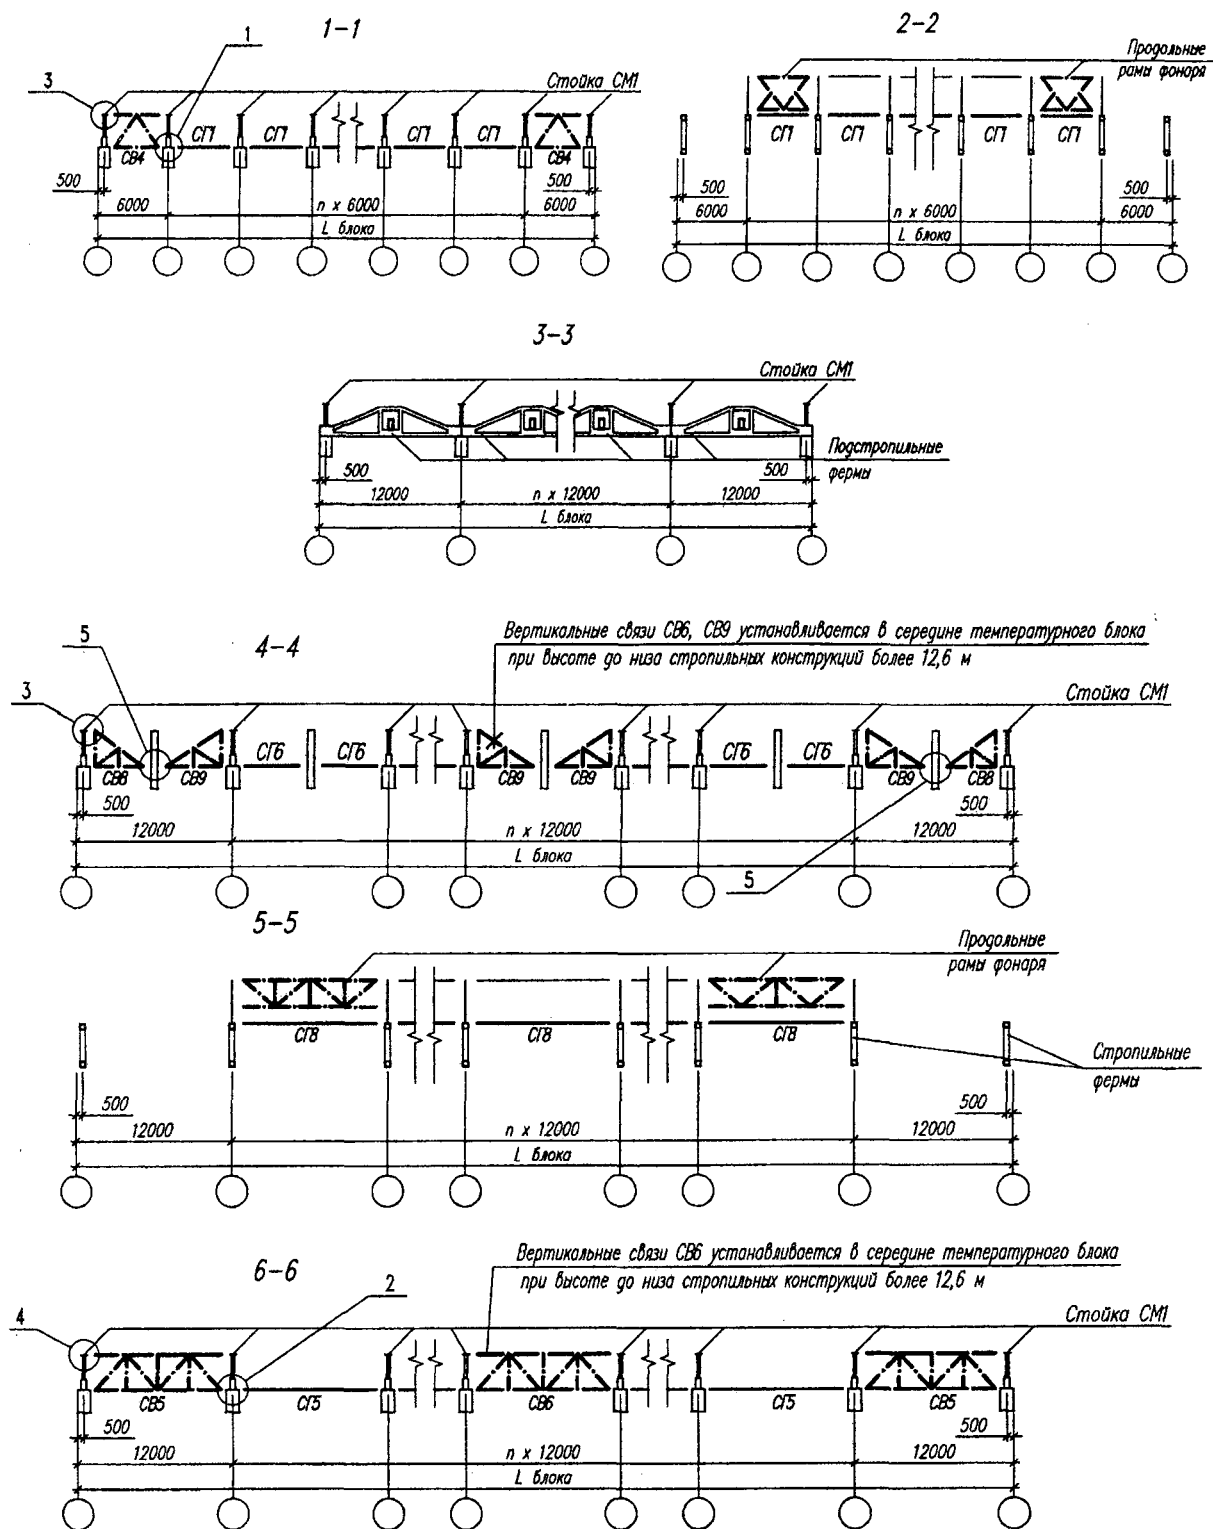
Расположение вертикальных связей и распорок в покрытиях с железобетонными фермами (разрезы обозначены на рис. 5.17–5.18)
